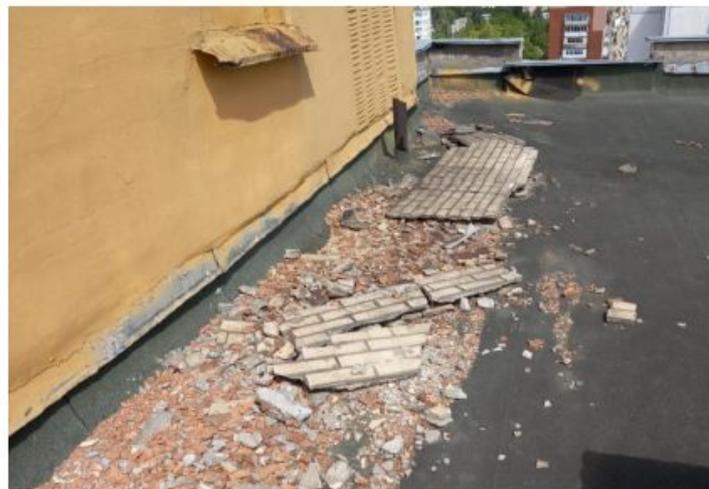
Мусор от отслоившейся плитки и разрушения кладки стен надстроек
